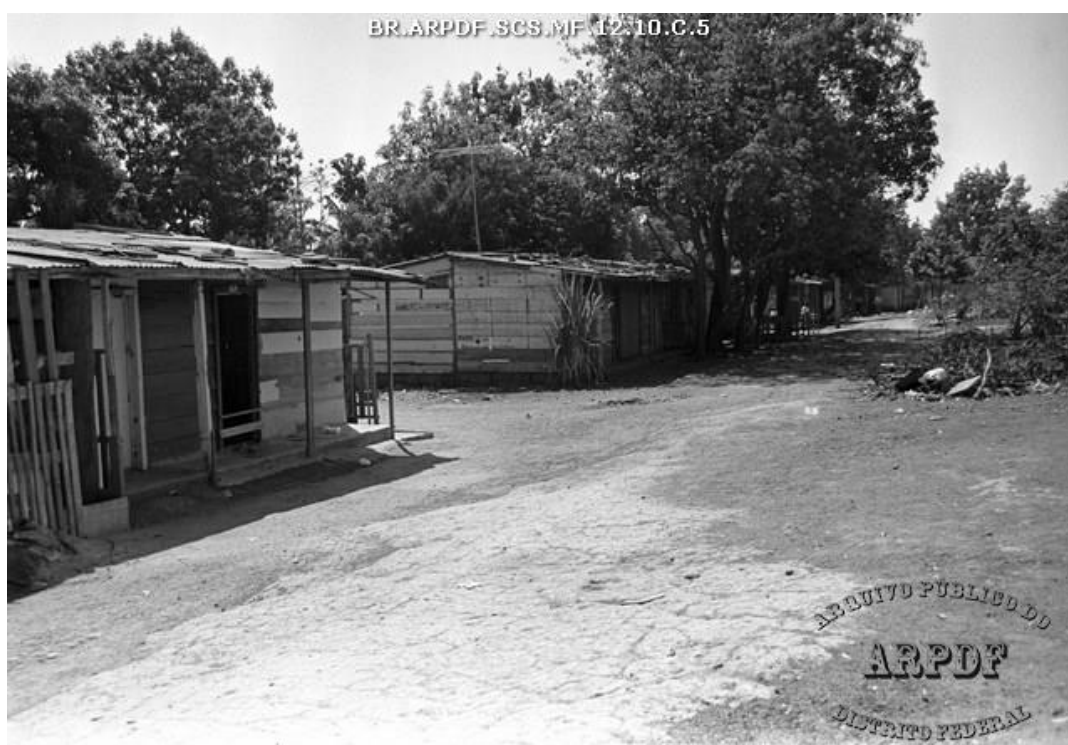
imagem de construções em madeira de construções do acampamento DFL da Vila Planalto. Foto do ARPDF, 1989
